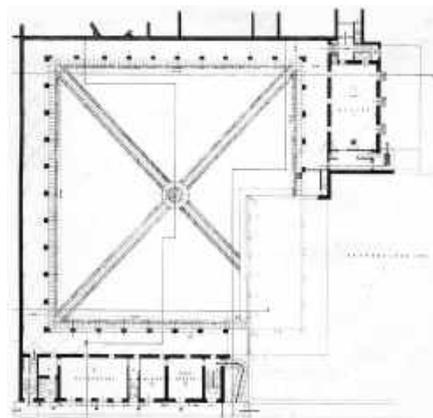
Chiostro, pianta piano terra, progetto di restauro
